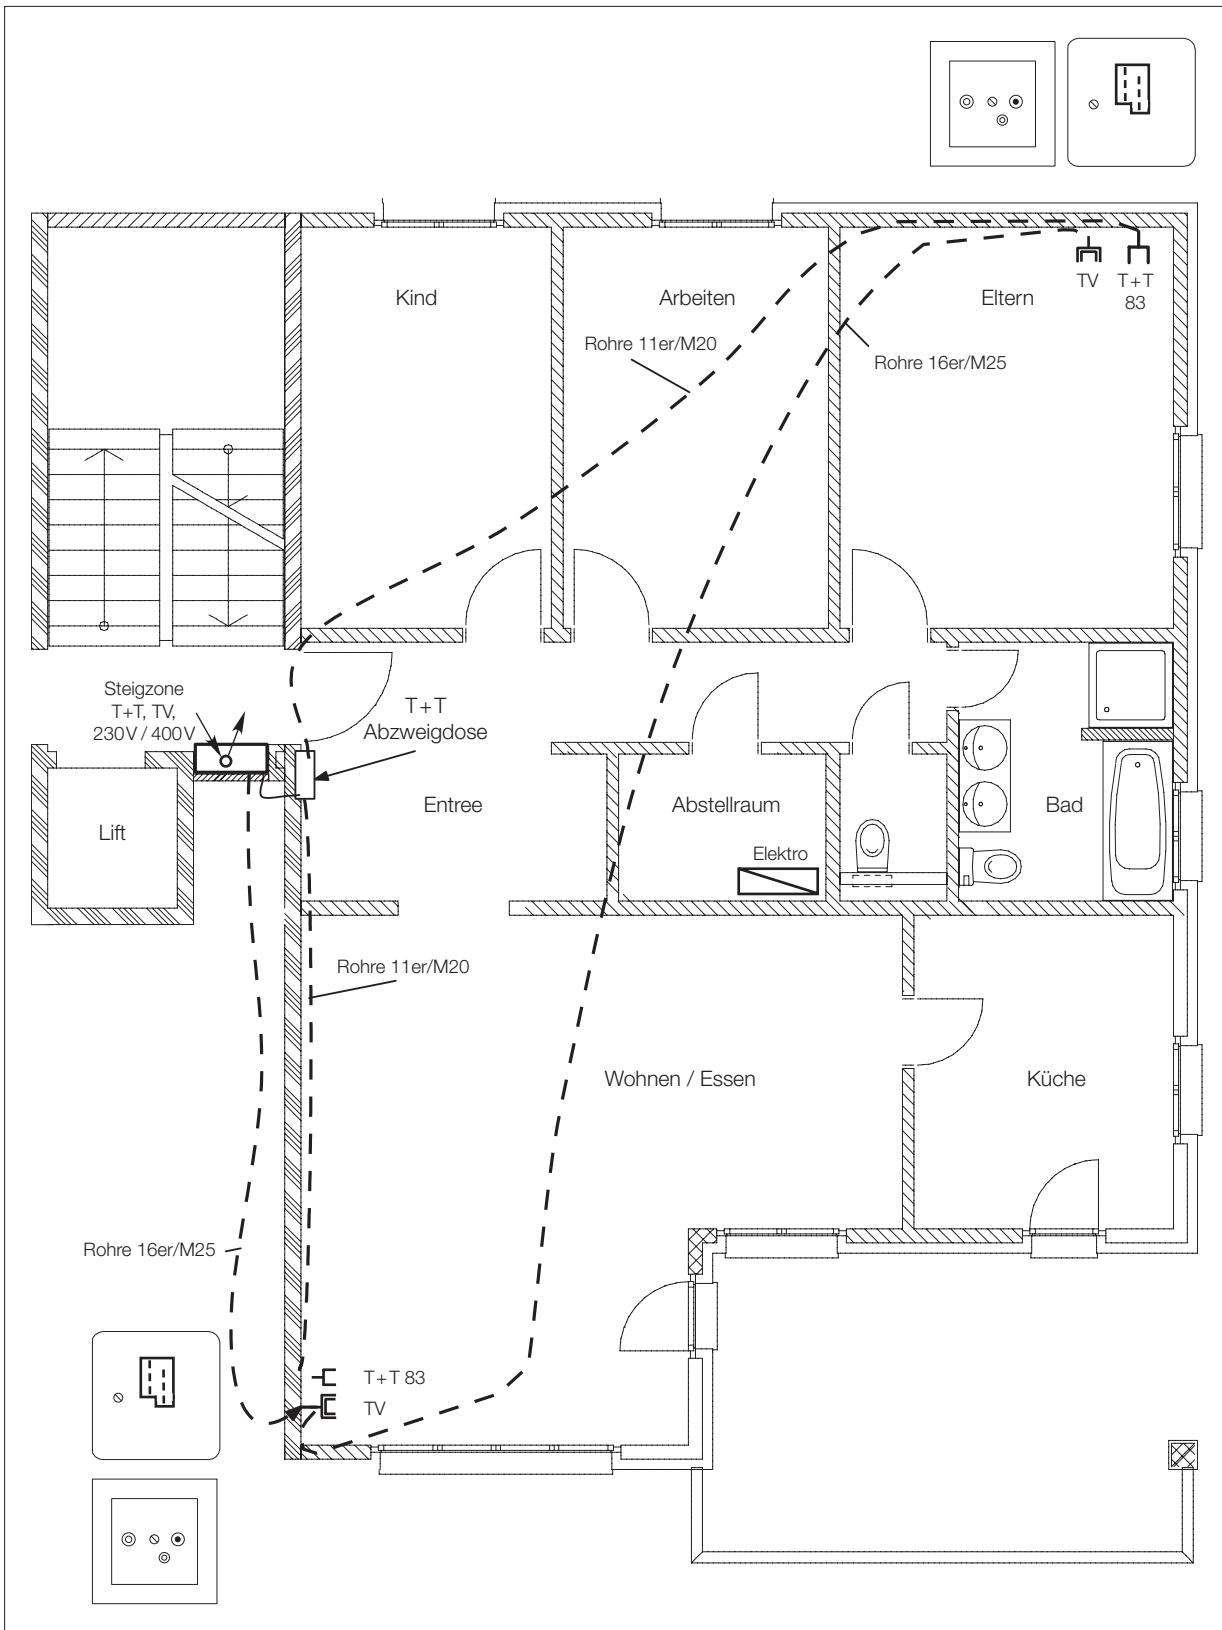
Die Grafik zeigt im Grundrissplan, wie bisher eine Wohnung ausgerüstet worden ist. Je ein Rohr wurde von der T+T-Abzweigdose zum Zimmer geführt. Oft wurden diese Zimmeranschlüsse noch untereinander verbunden.
